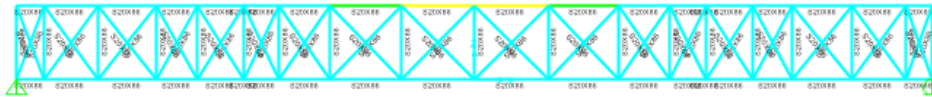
Chequeo de la estructura con la sección S20x86.
